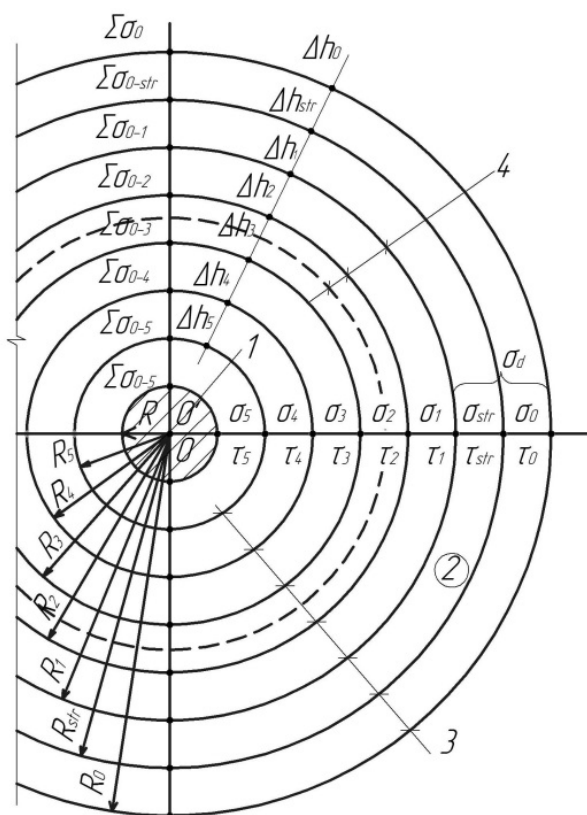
Схема зон состояний предельных равновесий грунта вокруг ствола сваи: 1 – свая; 2 – грунт напряженное основание сваи; 3 – границы зон; 4 – задействованные зоны
